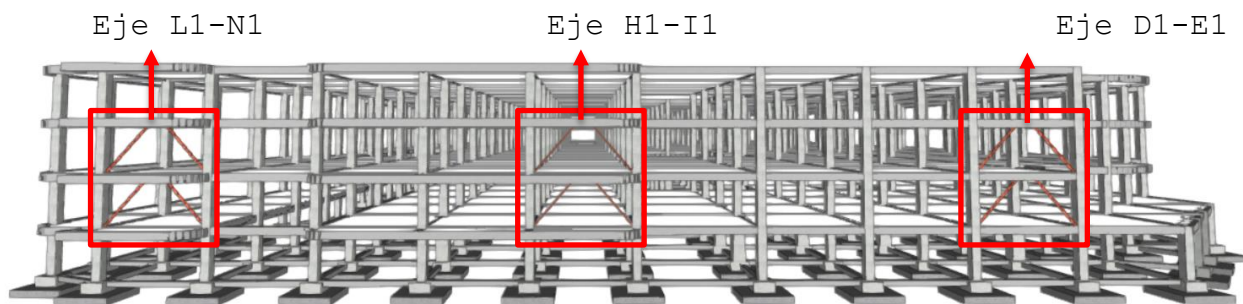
Arriostramiento excéntrico en el eje 1. Vista en alzado. Fuente: propia
